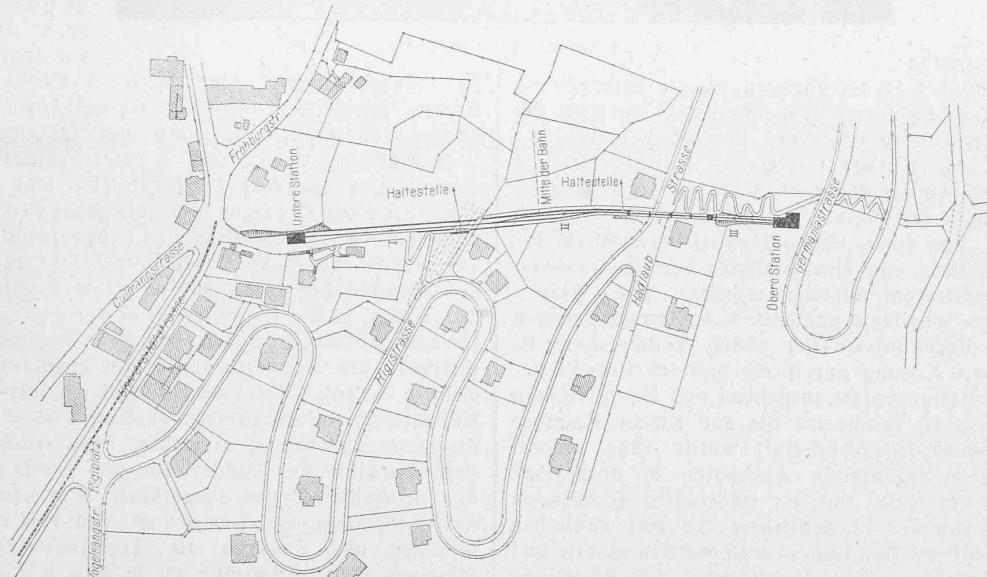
Lageplan des Rigiviertels und der Drahtseilbahn. — Maßstab 1 : 4000.
